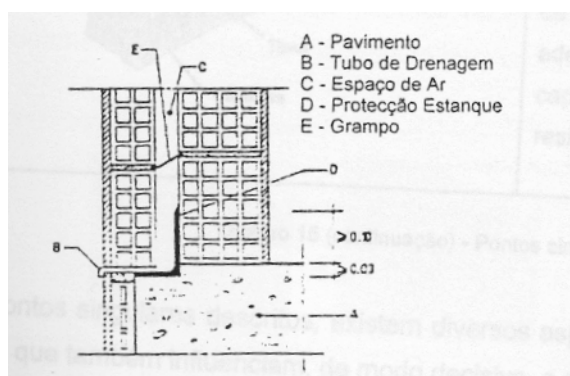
Impermeabilização e drenagem da caixa-de-ar
